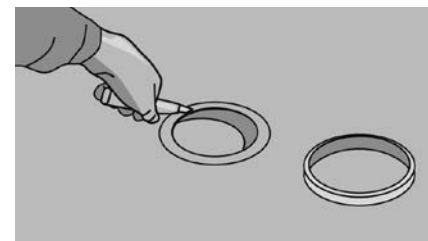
При укладке напольного покрытия вокруг труб рядом со стенами, надрежьте покрытие и прижмите его к трубе, чтобы сформировать «воротник». Если расстояние между трубой и стеной маленькое, сделайте надрез как показано на рисунке пунктирной линией. Если нужно сделать обшивку, вам необходимо:
